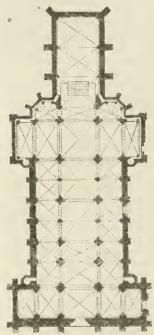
Grundrifs des Münsters zu Schlettstadt.
